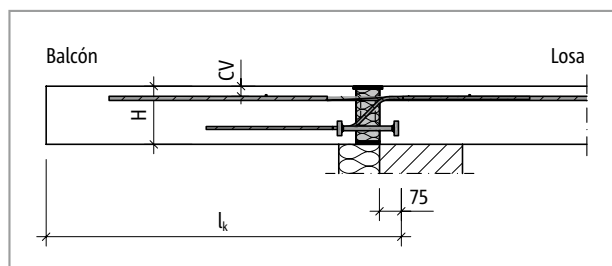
Schöck Isokorb® T tipo K-M12: Sistema estático
